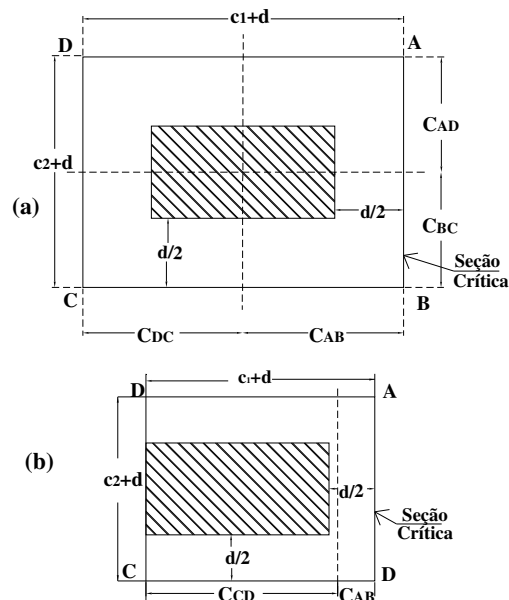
Seção Crítica para um pilar central (a) e pilar de borda (b)
